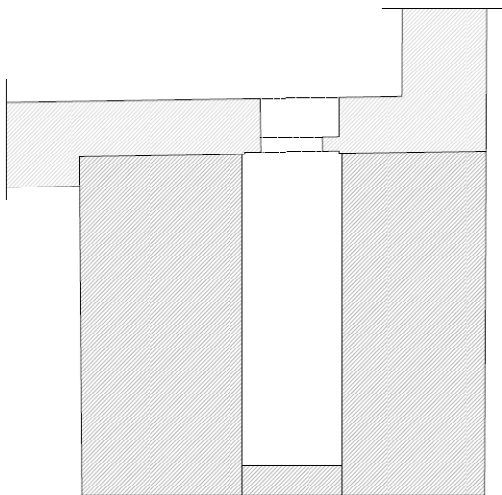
parte superior del arco ligeramente apuntado en el interior del campanario. Sobre él se construye un murete de un pie de ladrillo hueco doble y se cierra con un forjado de vigueta plementada con ladrillo hueco.
